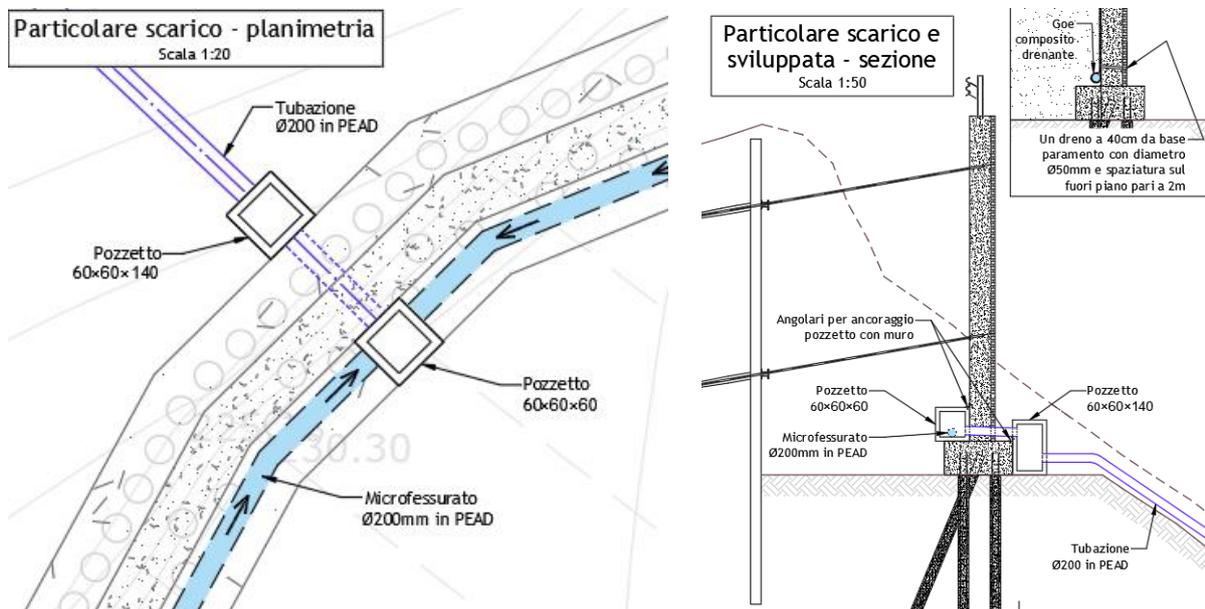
Opera di progetto, sinistra: planimetria; destra: sezione tipo
